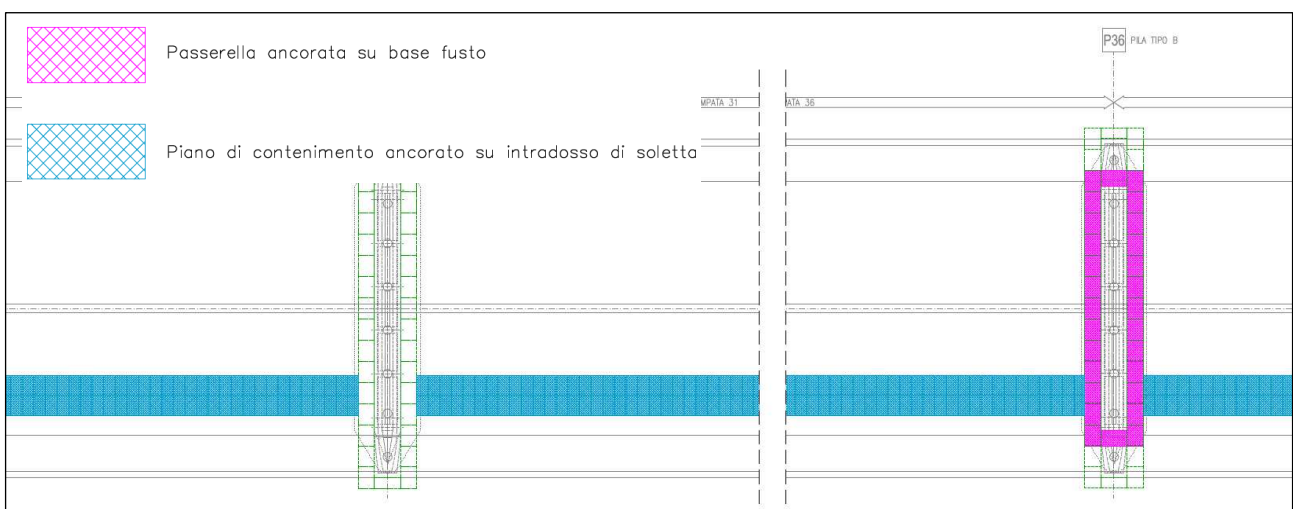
Planimetria illustrativa delle fasi di taglio dell'impalcato esistente, con indicazione delle opere provvisorie di contenimento per i tratti in alveo
